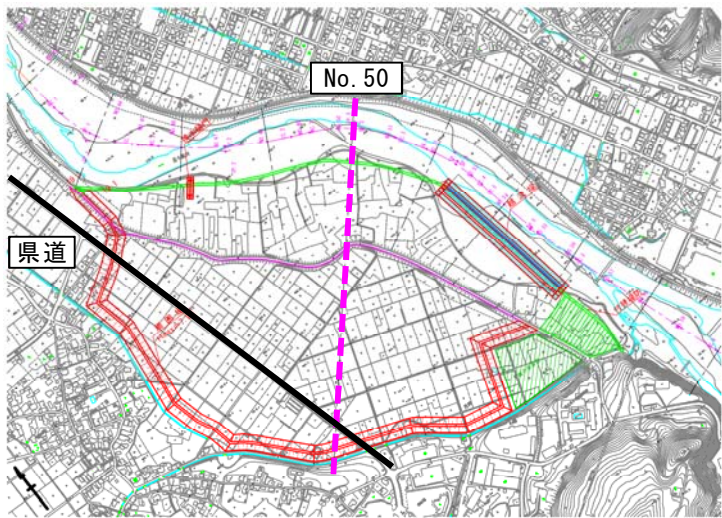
遊水地①（5.6k 左岸）平面図
